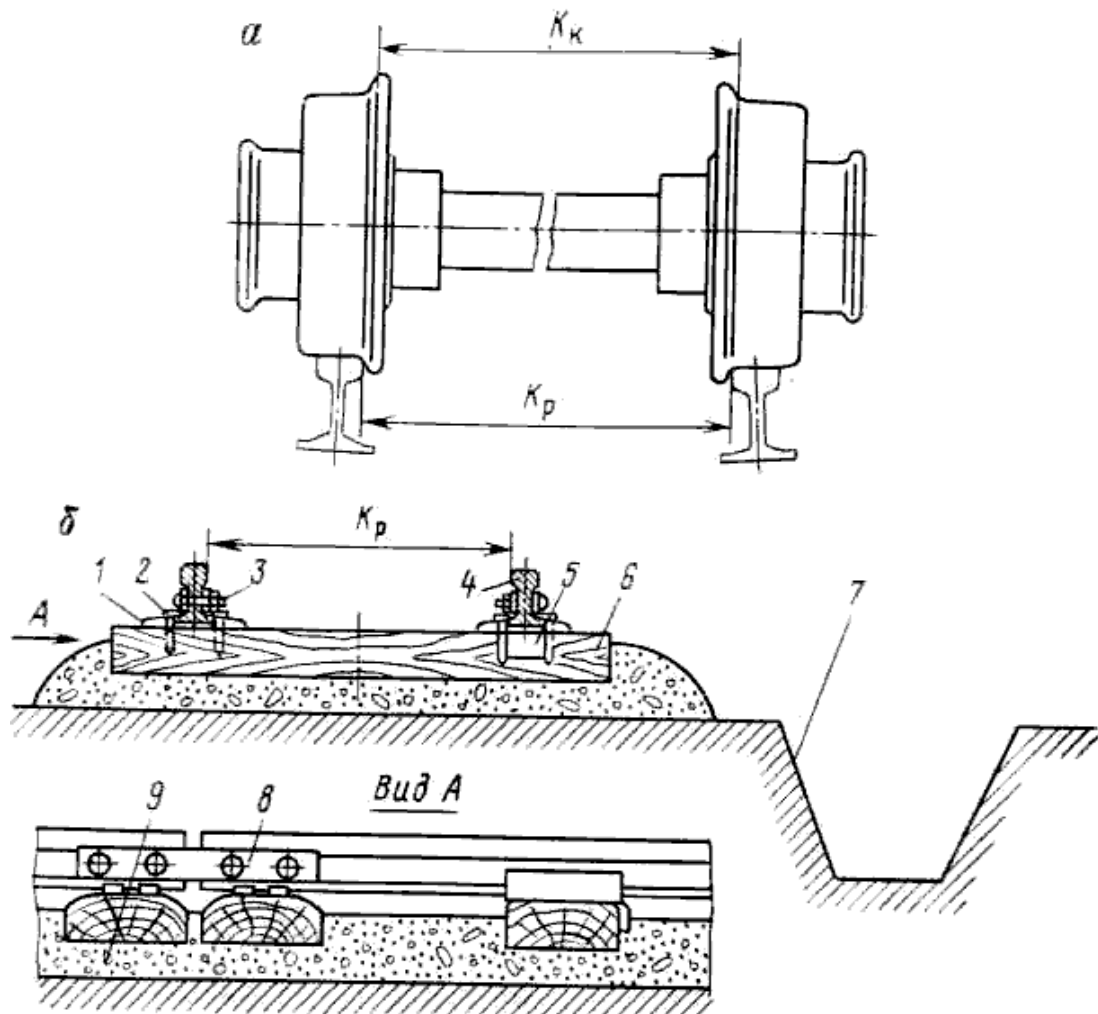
Элементы рельсового пути: а — схема расположения колес вагонетки на рельсах; б — строение постоянного рельсового пути: 1 — подкладка; 2 — костыль; 3 — болт; 4 — рельс; 5 — противоугон; 6 — шпала; 7 — водоотводная канава; 8 — накладка; 9 — балласт
